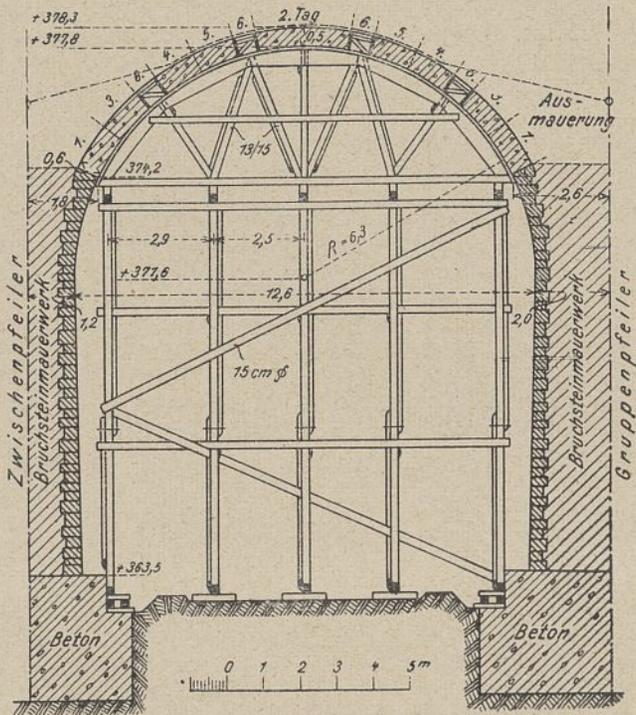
Lehrgerüst und Gewölbeeinbau der Brücke bei Heringhausen.
